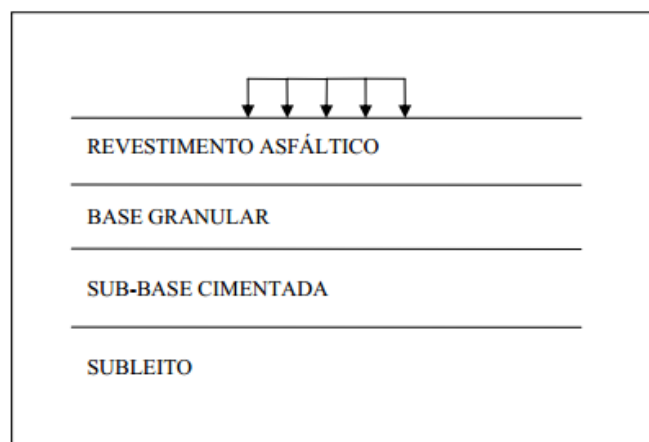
Estrutura Perfil da Seção Típica de um Pavimento Invertido.
